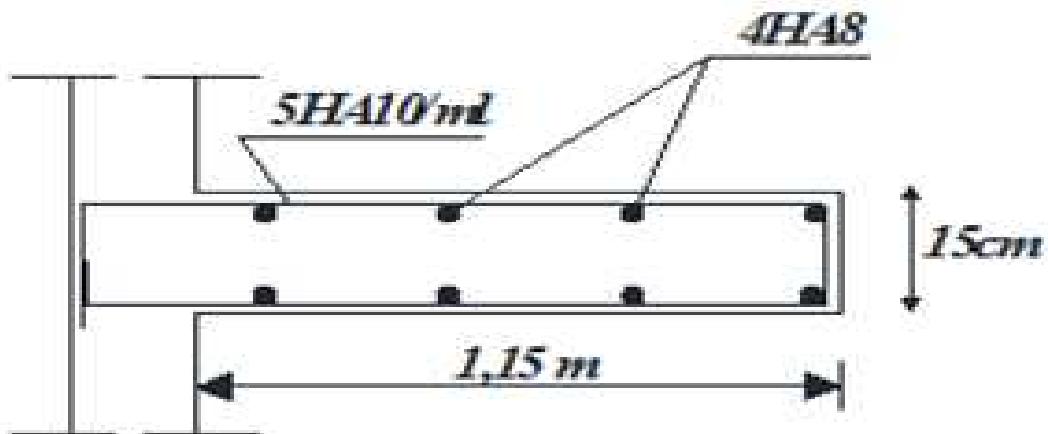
ferrailages du balcon reposant sur deux appuis
